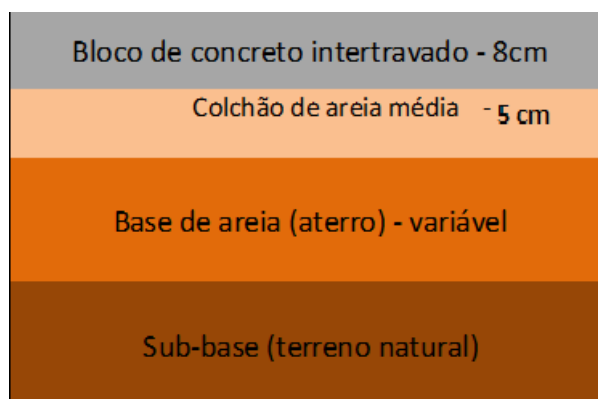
Camadas do pavimento de bloco de concreto intertravado
